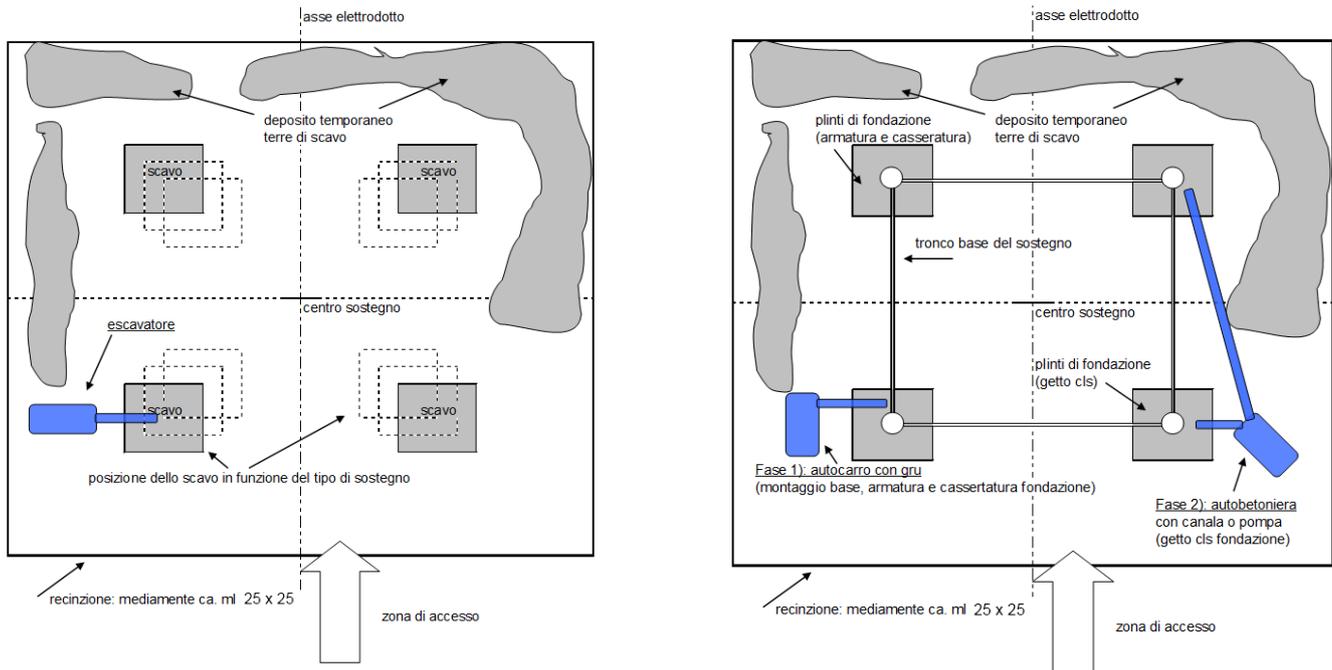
Planimetria dell’Area Sostegno (scavo di fondazione - getto e basi), tipologico
